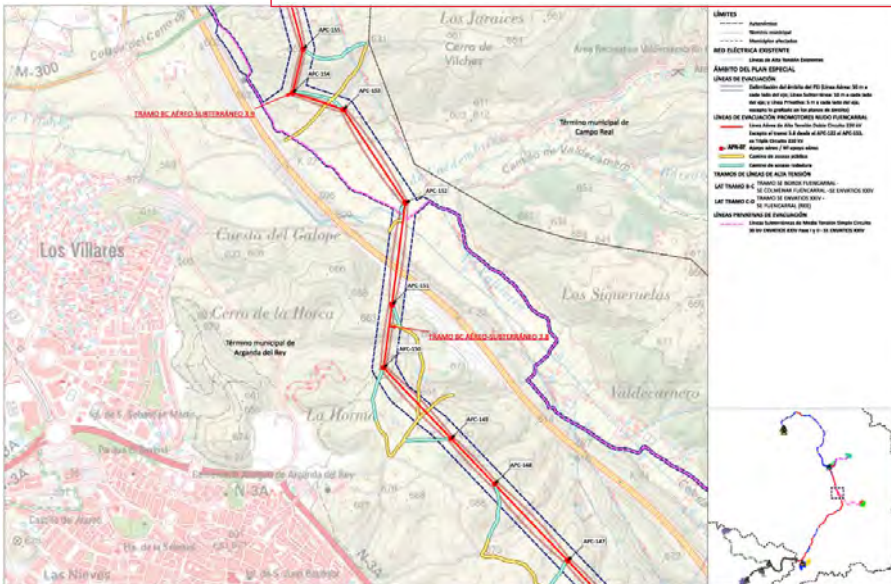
Plano de Ordenación O2.3.12. Planta por tramos. LASAT Promotores Nudo Fuencarral Tramo B-C
